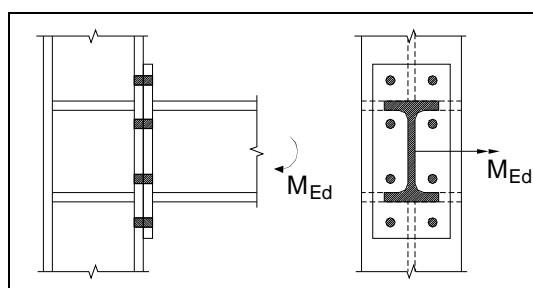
Ligação viga-coluna, unilateral, com chapa de topo.
